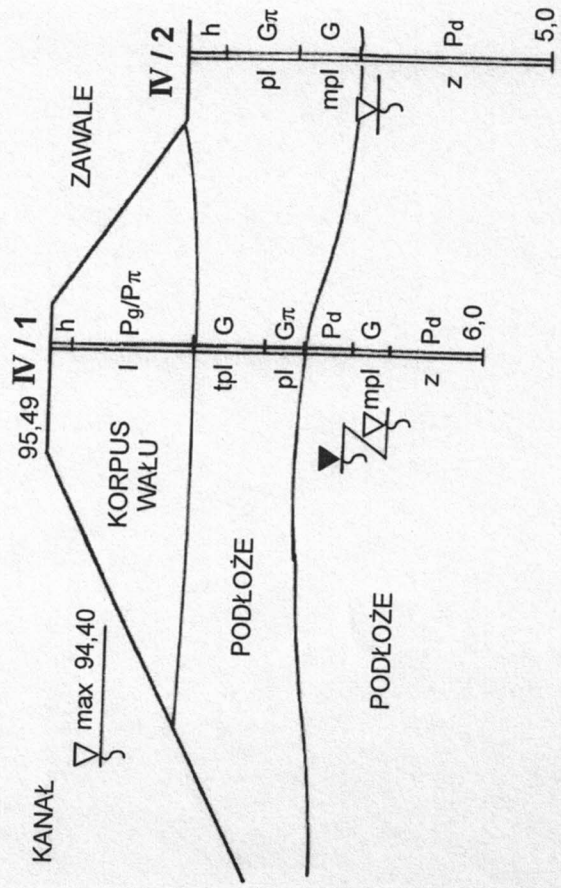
WAŁ LEWY PRZEKROJE GEOTECHNICZNE
